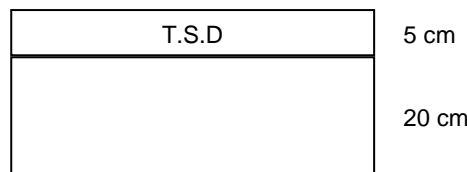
Estructura de pavimentos con tratamiento superficial doble y subrasante mejorada
